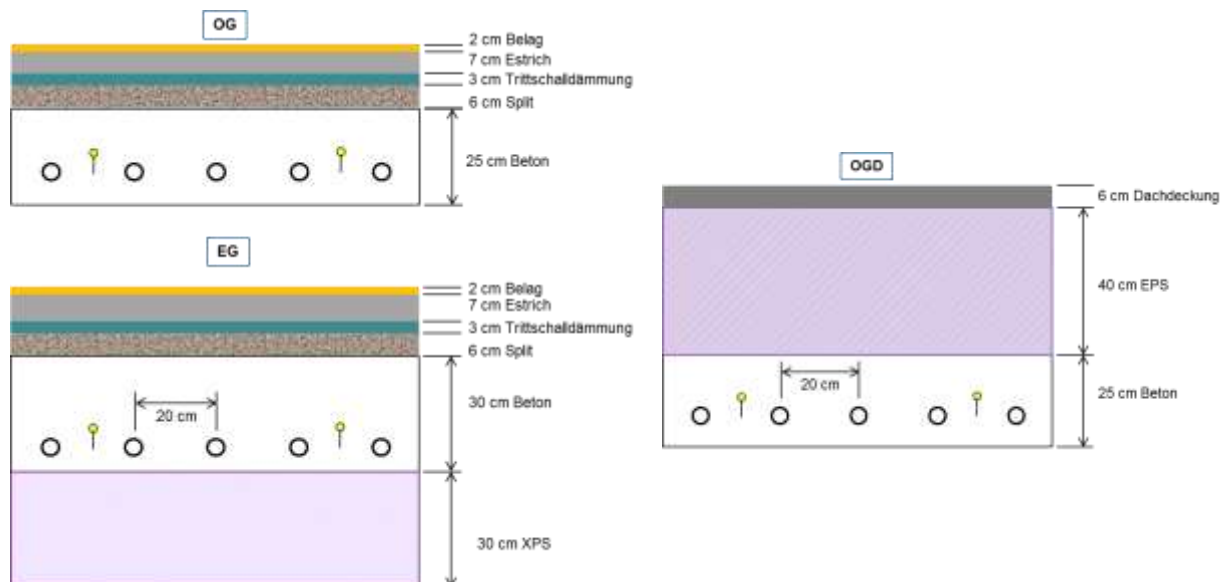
Aufbau der Fundamentplatte (EG), der Zwischendecke (OG) und der obersten Geschossdecke (OGD) (Quelle: Einreichplan, eigene Darstellung)
